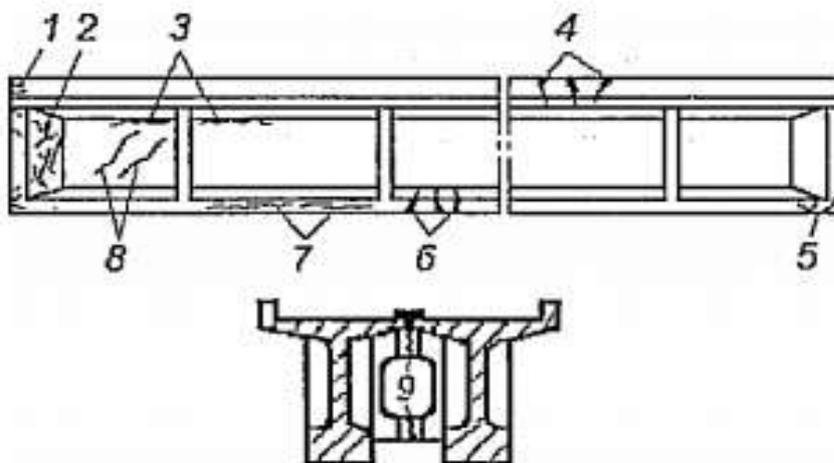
Трещины в железобетонном балочном пролетном строении.
